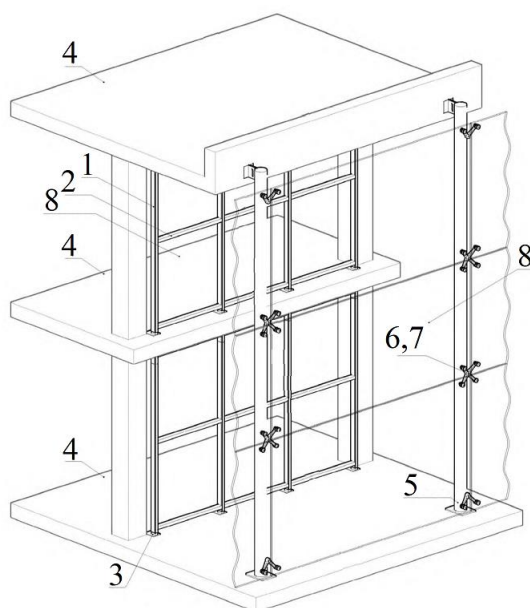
Схема комбинированной фасадной системы на основе стоечно-ригельной и фахверковой конструкций: 1 – стойка; 2 – ригель; 3 – кронштейн крепления; 4 – несущие конструкции здания; 5 – фахверк; 6 – несущий кронштейн; 7 – болтовая опора; 8 – заполнение
